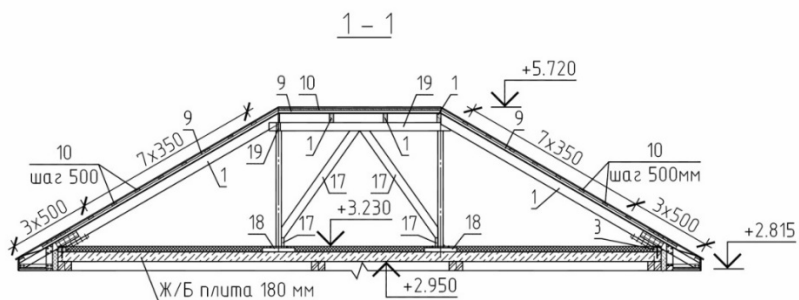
Устройство кровли. Поперечный разрез мансардного этажа на отметке +3.230
